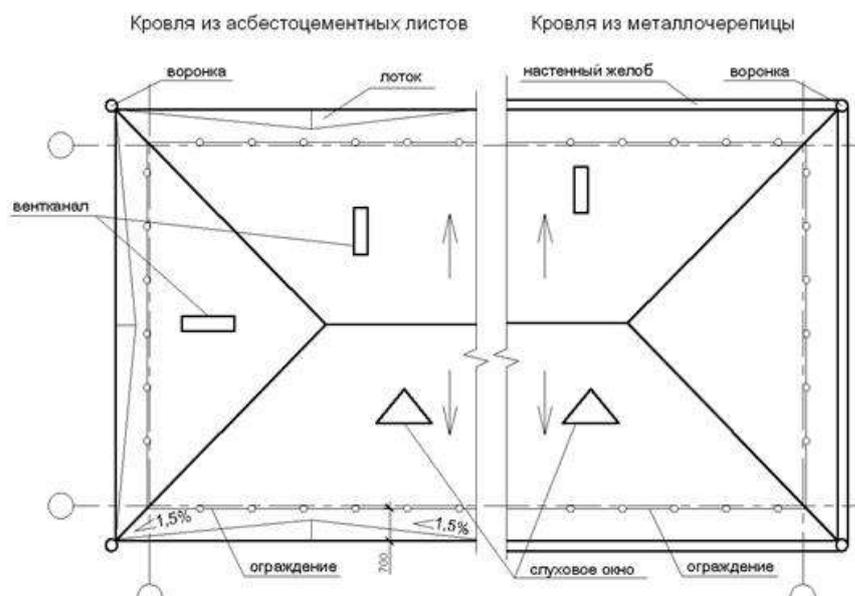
Виды кровли из асбестоцементных листов и кровли из металлочерепицы
